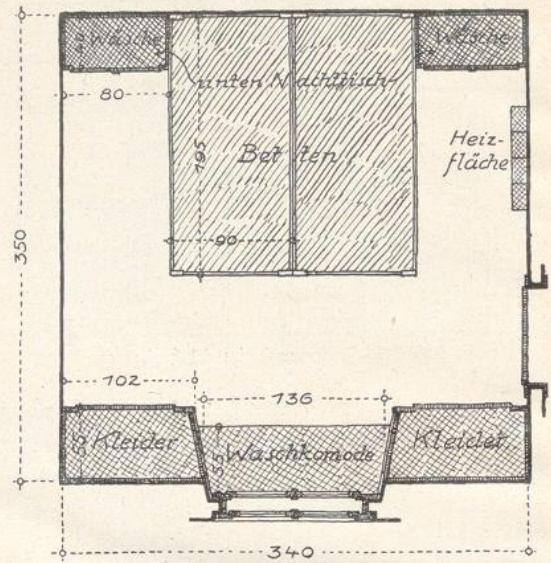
Grundriß des Elternschlafzimmers (1:50)
